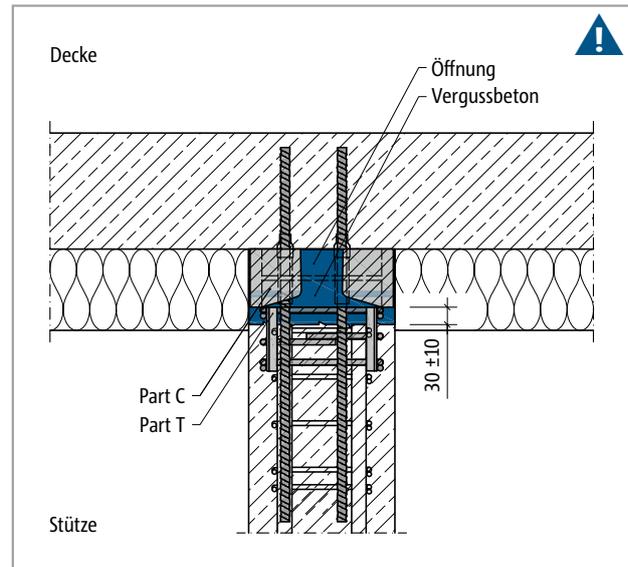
Schöck Sconnex® Typ P: Einbausschnitt; Anschluss Stütze - Decke mit Formschluss zum Stützenbeton durch PAGEL®-Verguss V1/50
